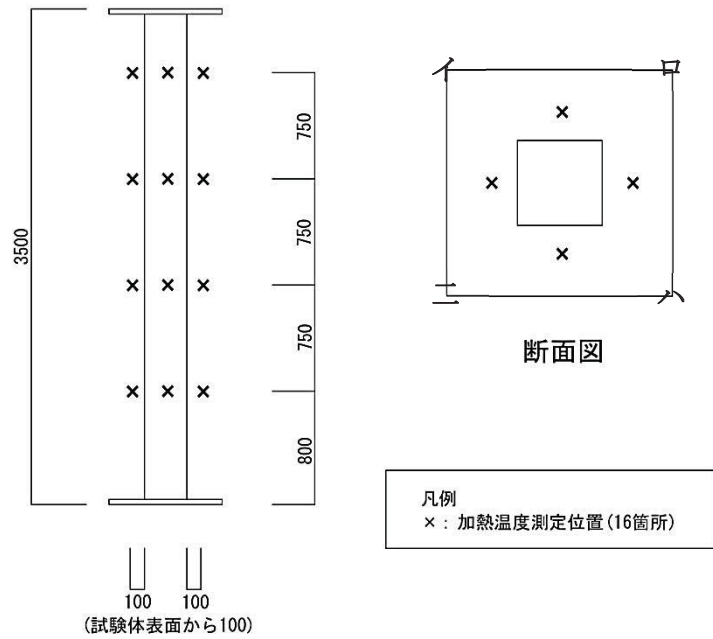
耐火炉の炉内温度熱電対の配置図
